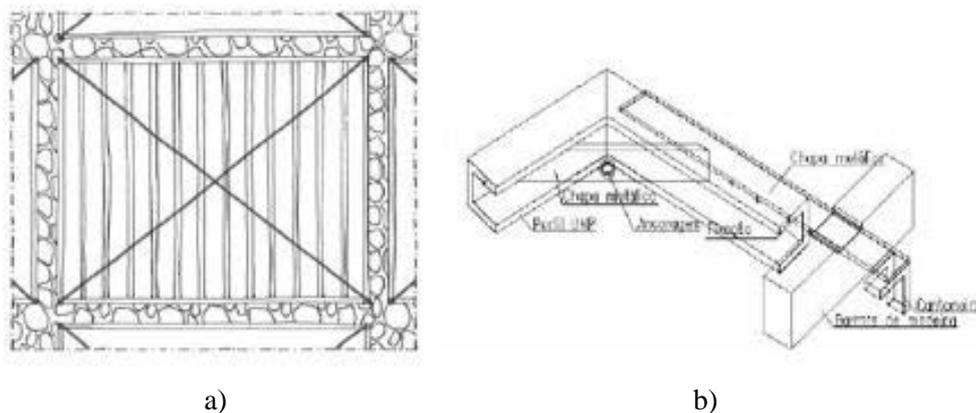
a) Reforço do pavimento com tirantes de aço; b) Pormenor da ligação nos cantos (Branco, 2007)
